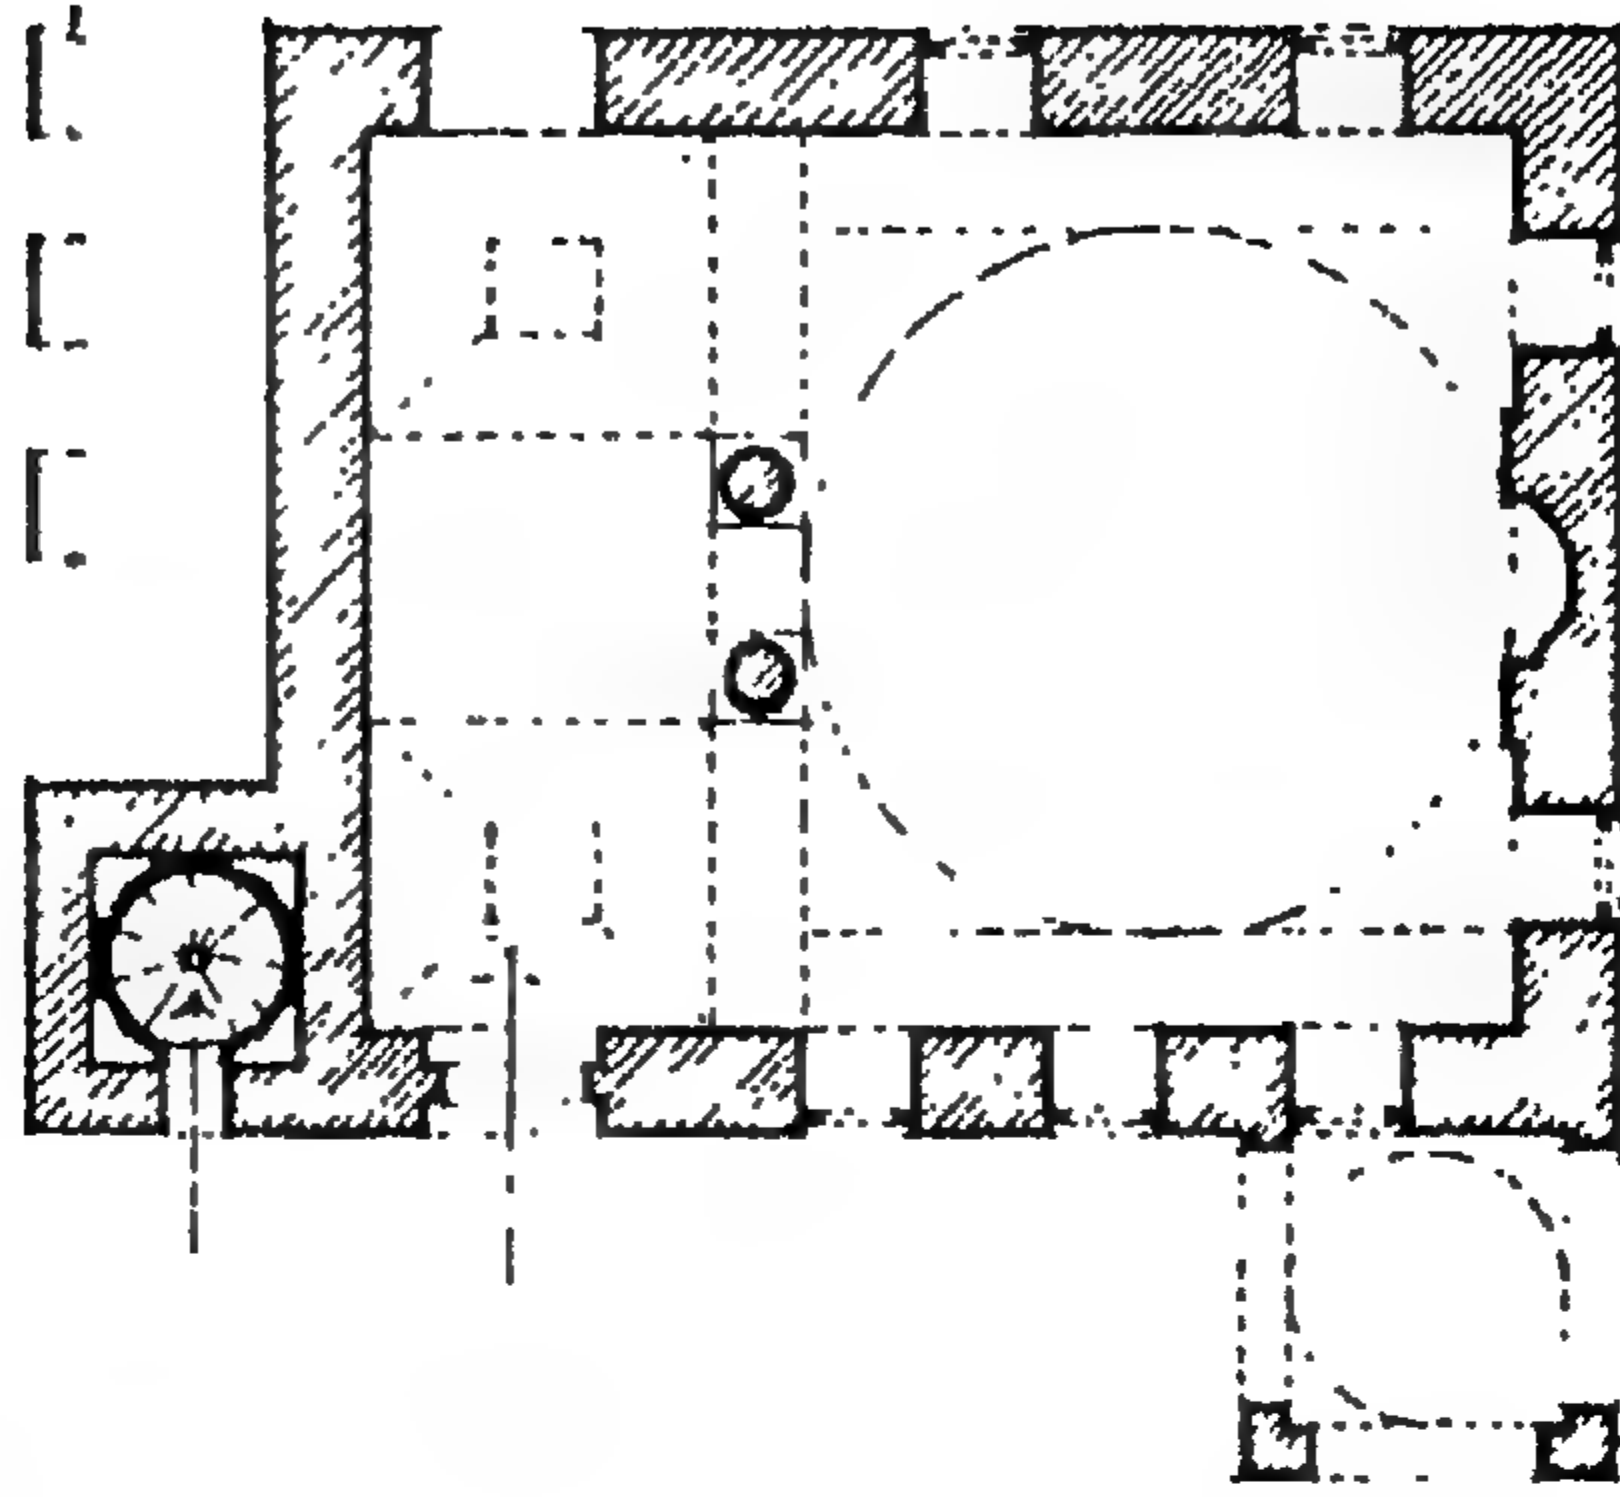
مسقط أفقي لجامع بايزيد يلديرم في مودورنو . (عن : Kuran) .
